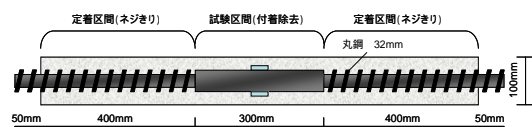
鉄筋埋設ひび割れ試験用供試体
